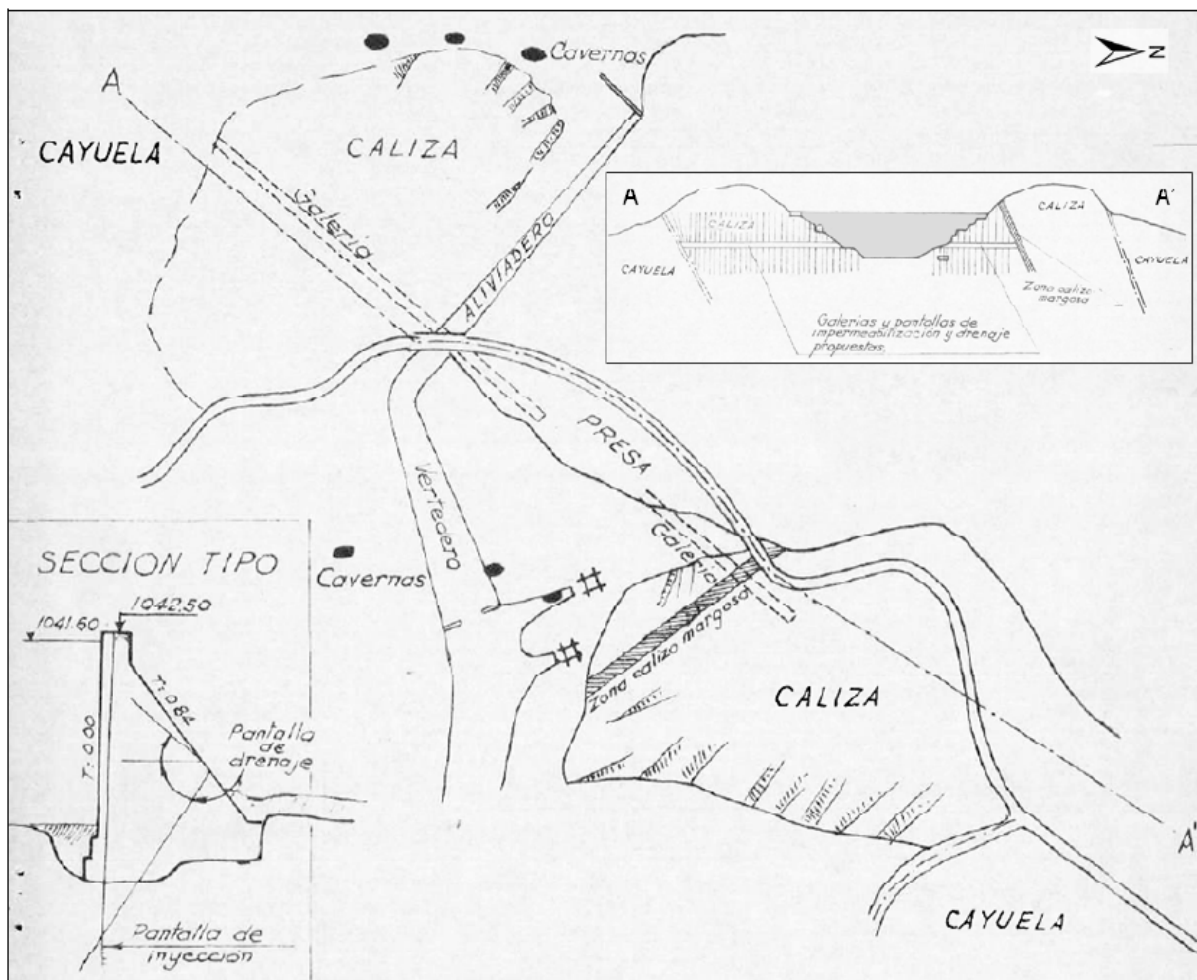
Detalles de las futuras obras de impermeabilización de la presa
